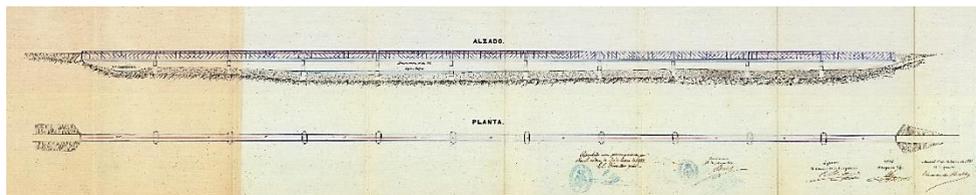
Alzado y planta del puente, tipo Linville, sobre el río Guadiana (1882). Colección autor.
